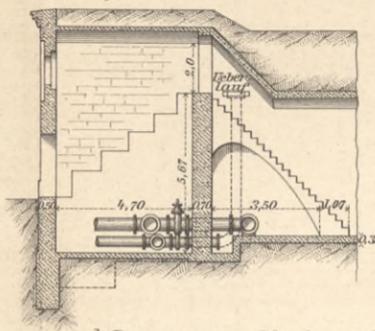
<sup>a-d</sup> Behälter zu Minden i. W. (Stampfbeton). M. 1:250.
